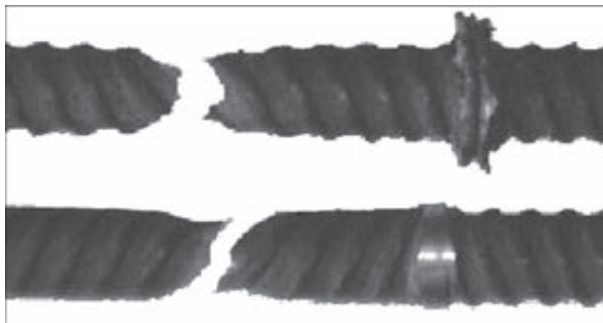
Сварные соединения арматуры, полученные с помощью КСС, после испытаний на растяжение
